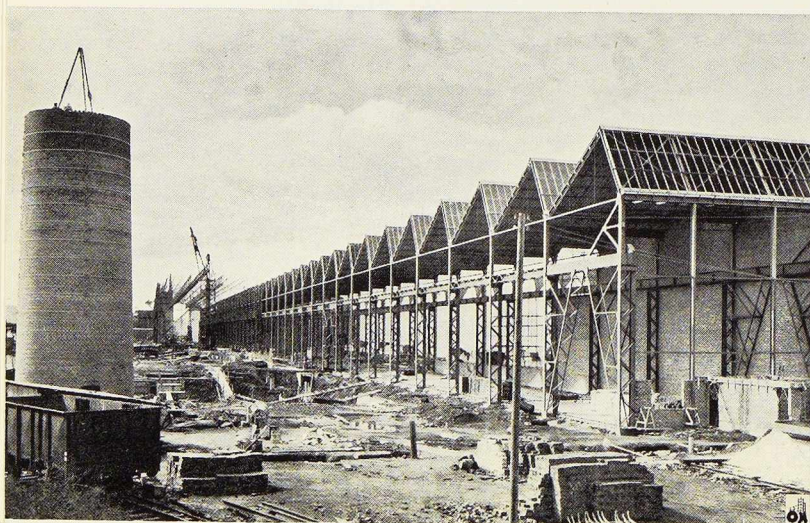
Vue des charpentes de toiture en shed des halls conçus de façon à supprimer toute barre - triangulation apparente une fois la sous-toiture placée.
